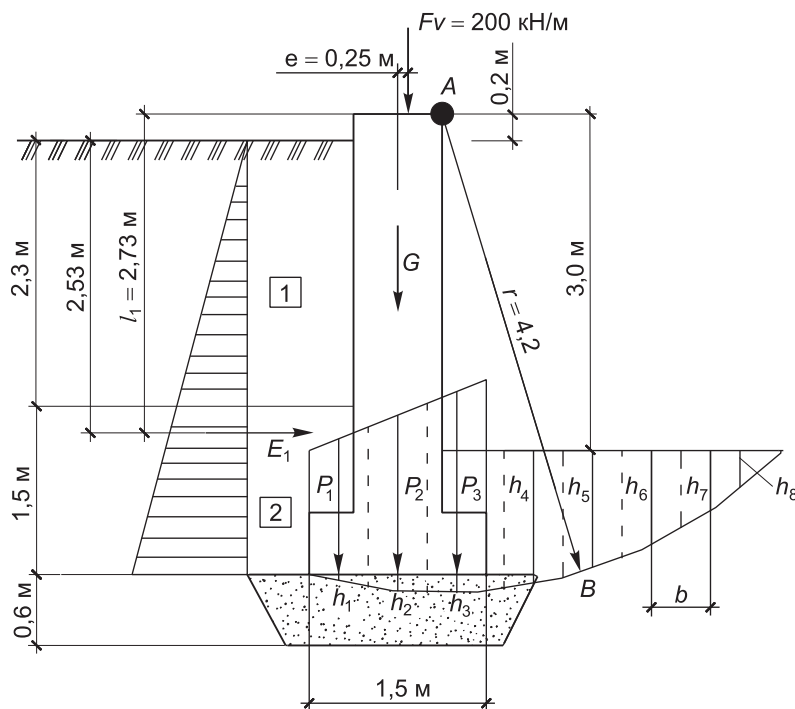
Расчетная схема стены подвала к примеру Г.13
